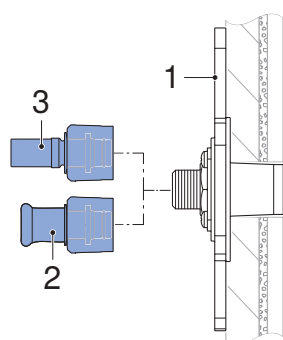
Conexão reta, com Geberit MasterFix, instalação em parede ligeira/falsa
